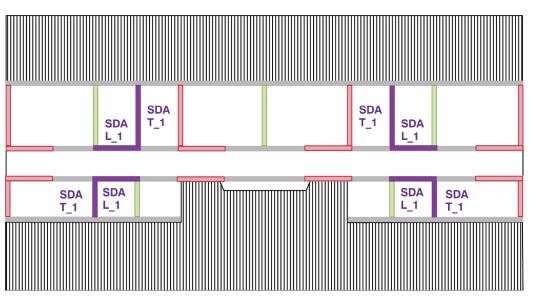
Schema di disposizione in pianta dei sistemi dissipativi aggiuntivi.
